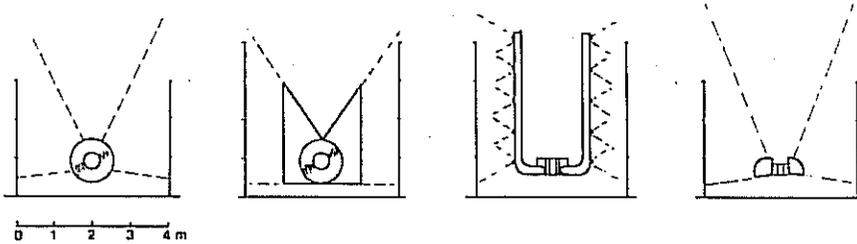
Schema in scala delle macchine impiegate e loro disposizione rispetto ai banchi.
